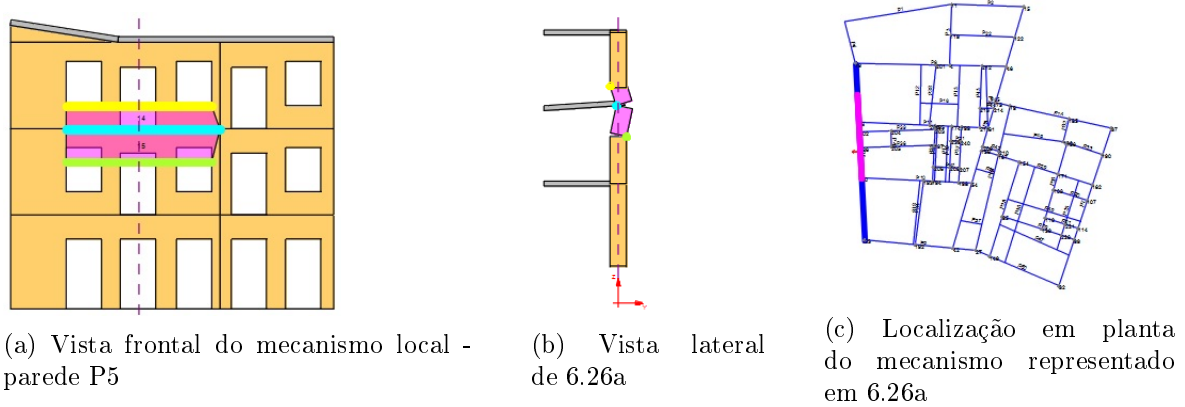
Mecanismo local (pormenor de ligação viga metálica - fachada em pedra)
